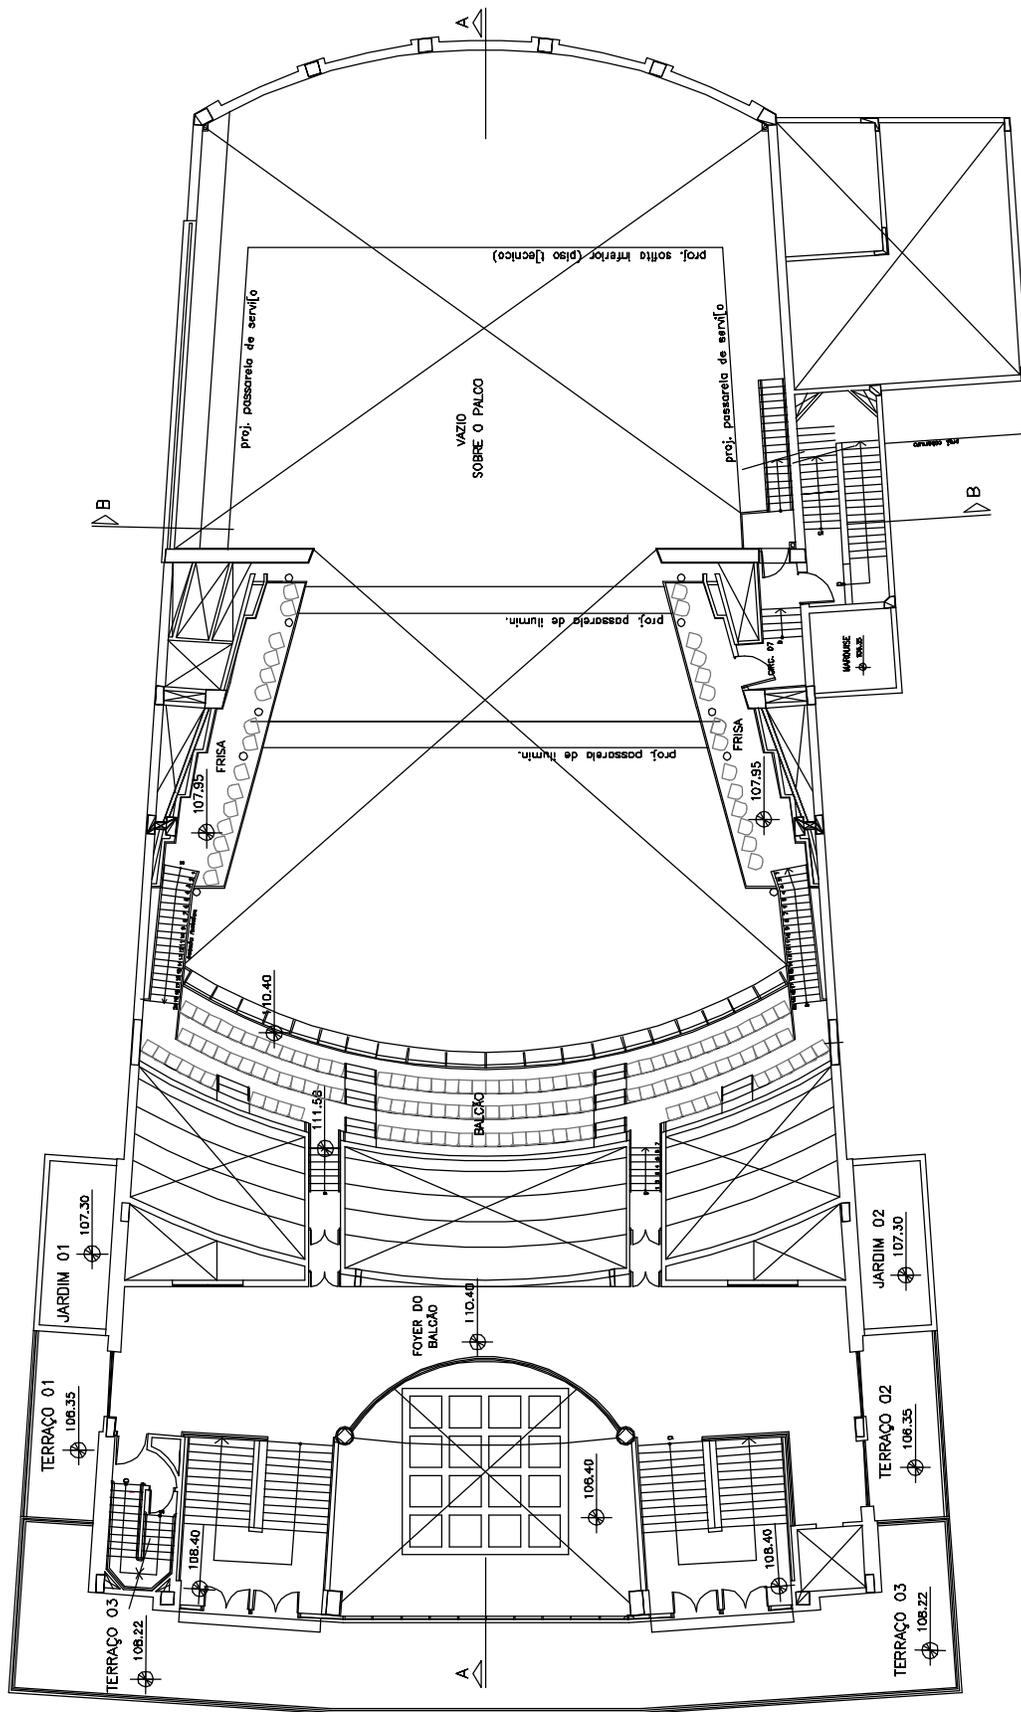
Planta do Balcão – Teatro Alfa de Cultura – Esc. 1/250
